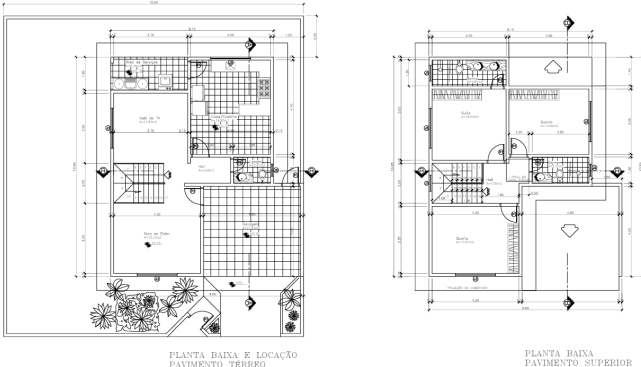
Planta Baixa Térreo e Pavimento Superior sem escada
